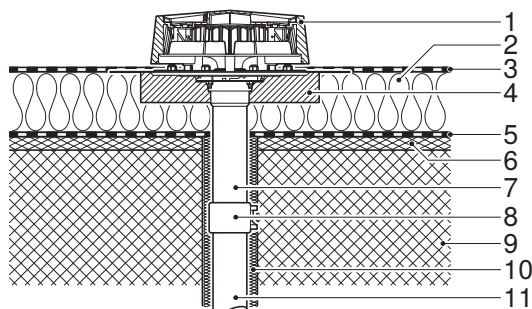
Montage dans toiture massive isolée avec étanchéité de la toiture bitumineuse
